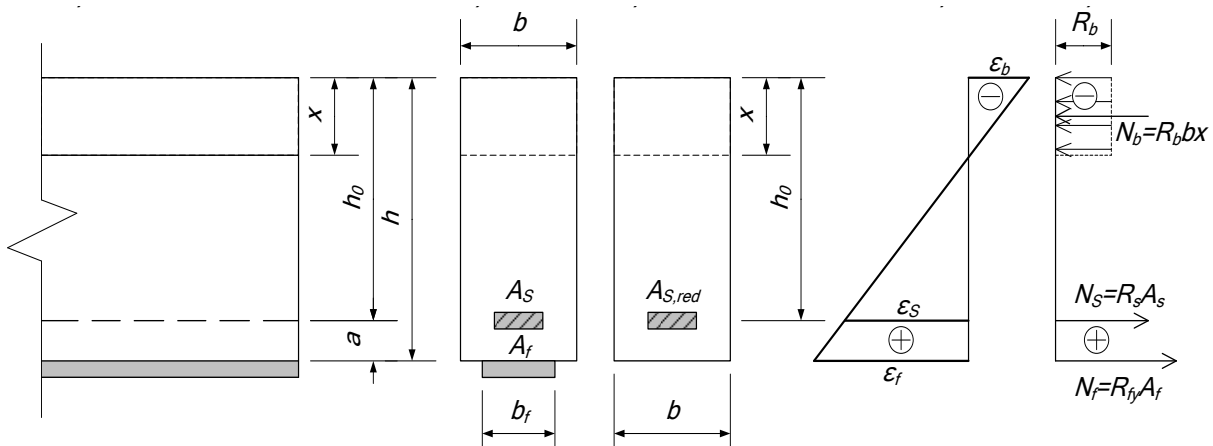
Розрахункова схема нормального перерізу залізобетонної балки, підсиленої зовнішньою композитною арматурою
